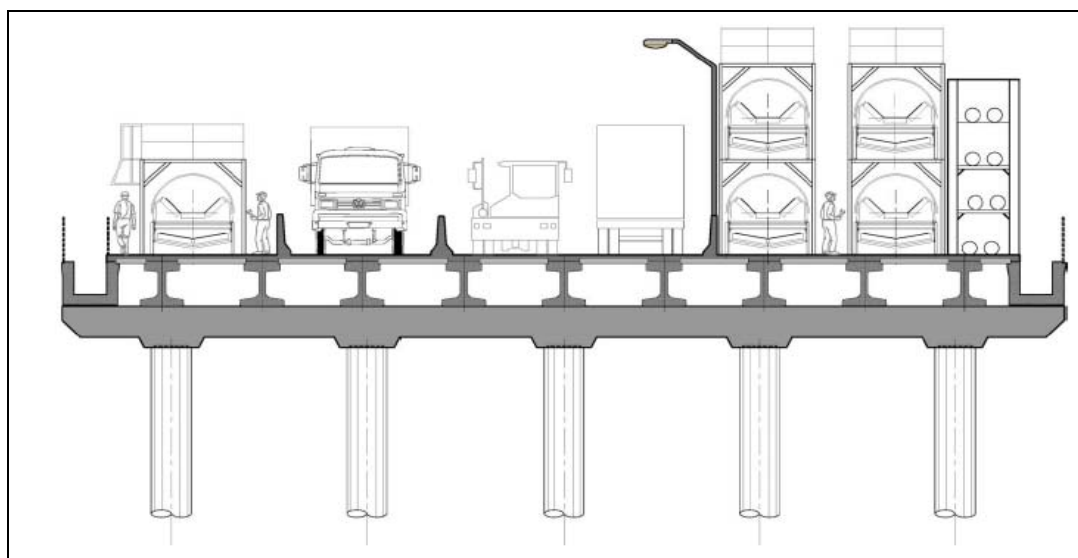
Seção transversal da ponte de acesso ao Porto Sul (cortesia Concremat)
